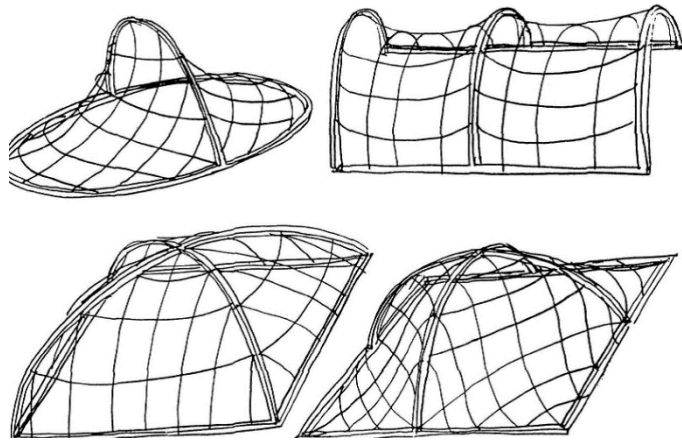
Estructuras tensadas entre marcos rígidos.
